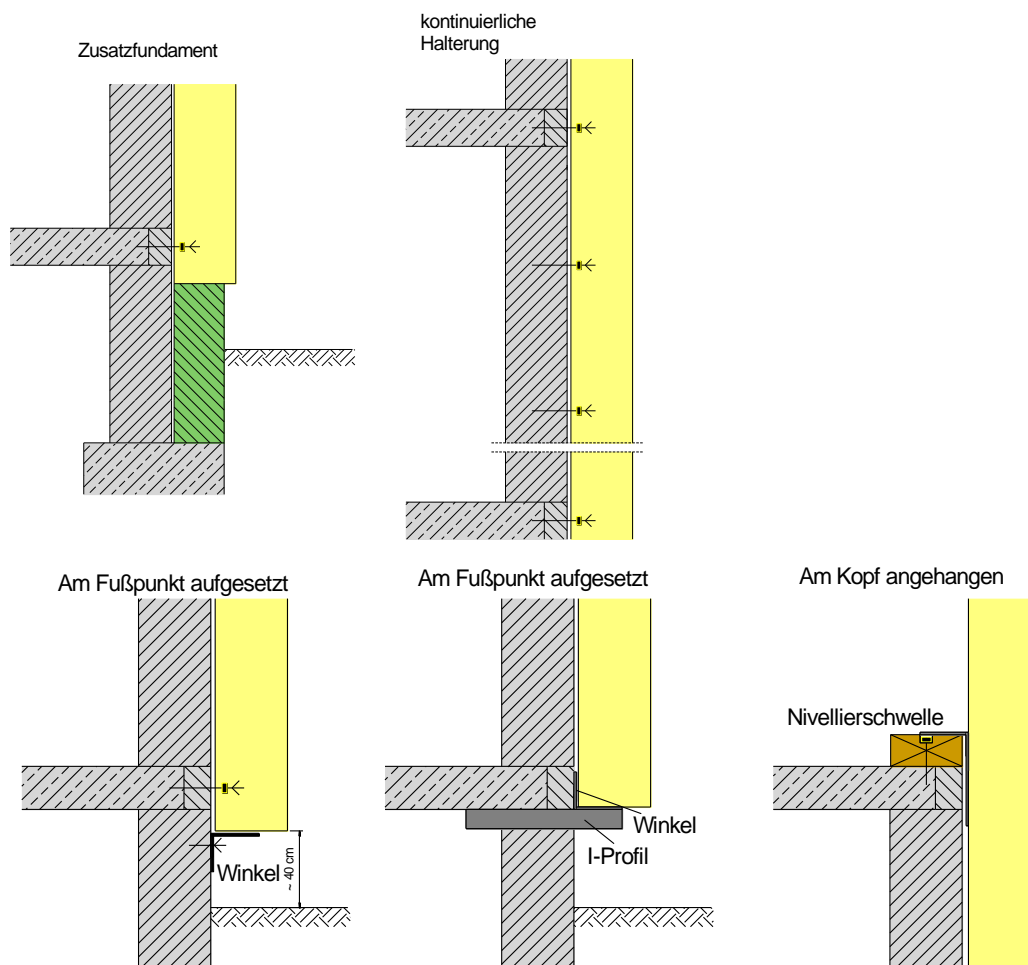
Verankerung der Elemente (vertikaler Lastabtrag)
